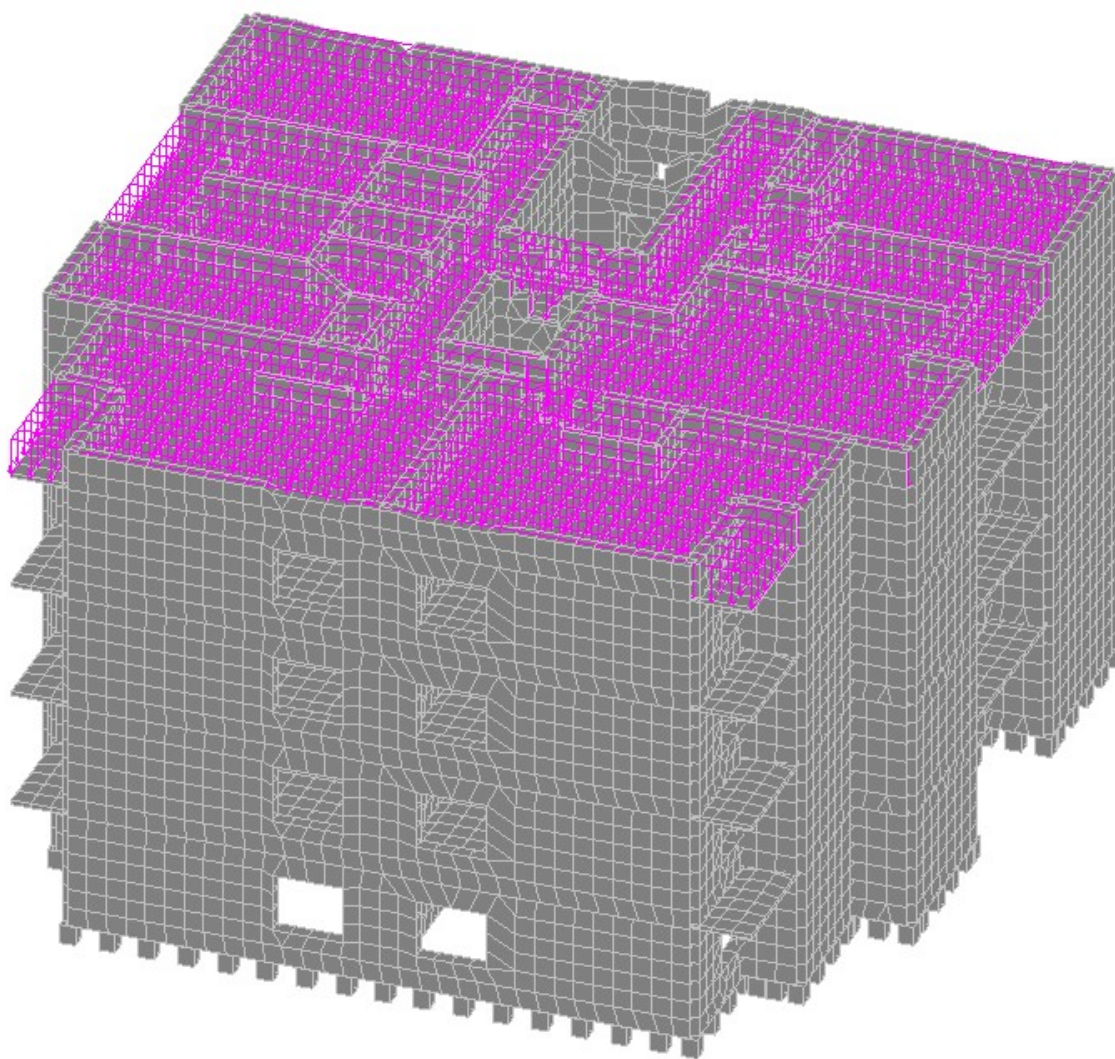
Равномерно-распределенная нагрузка на плиты перекрытия
